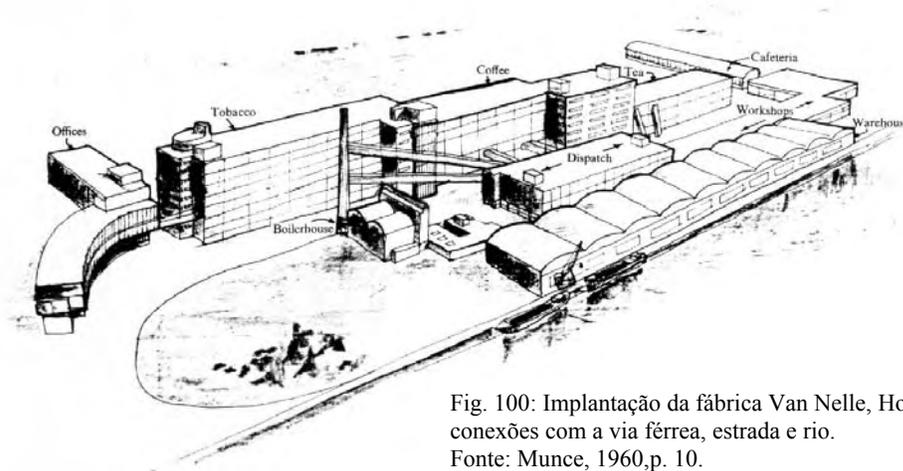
Implantação da fábrica Van Nelle, Holanda. Organização em unidades e conexões com a via férrea, estrada e rio.
